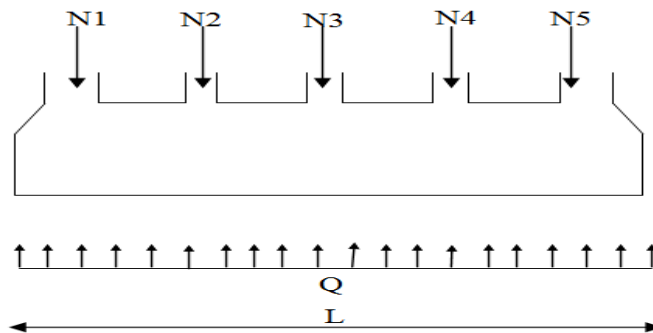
Charges agissantes sur la poutre de rigidité.
